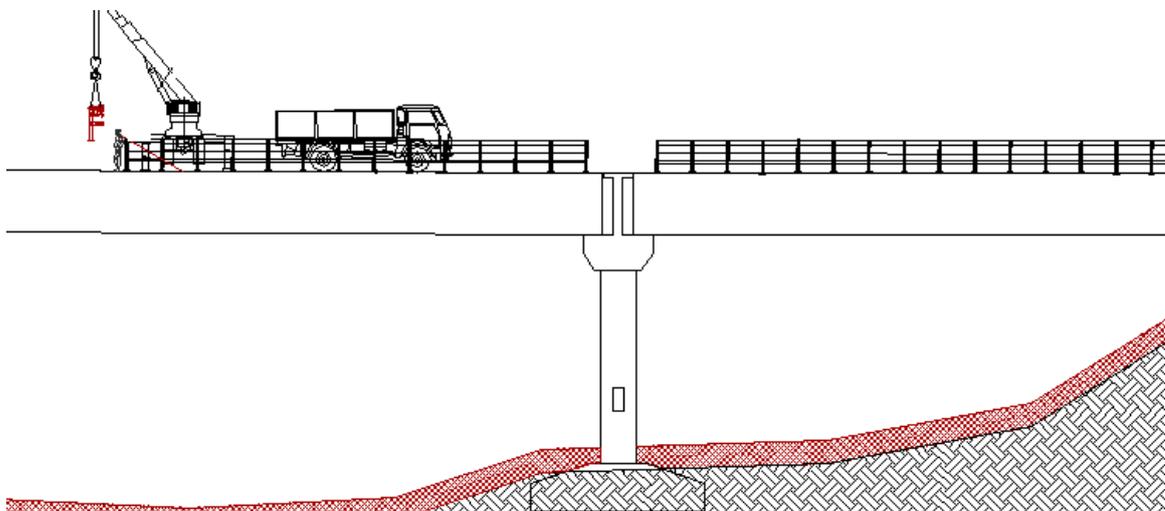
FASE III: Schema generale della rimozione delle barriere di sicurezza
